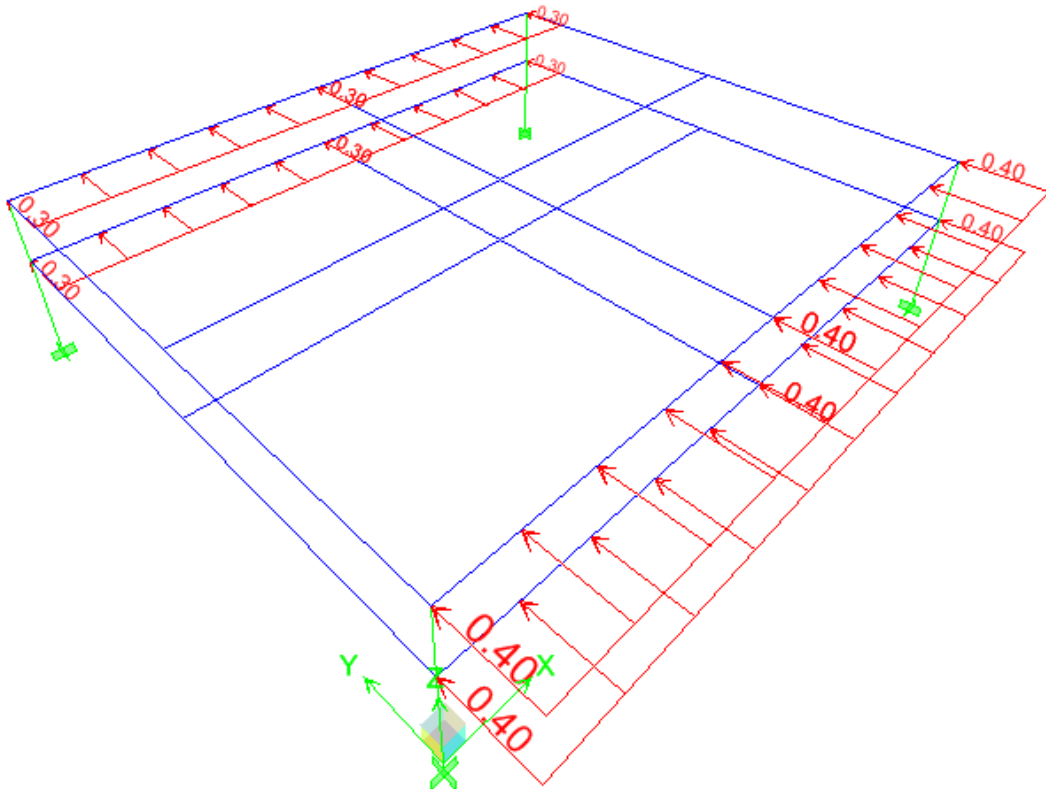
Tĩnh tải do bản nắp và bản đáy truyền vào
